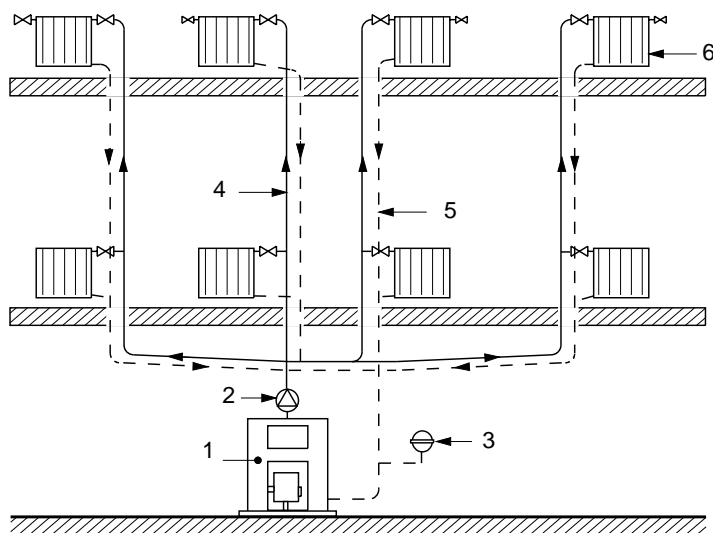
Principe d'une installation de chauffage central à eau chaude (bitube).
